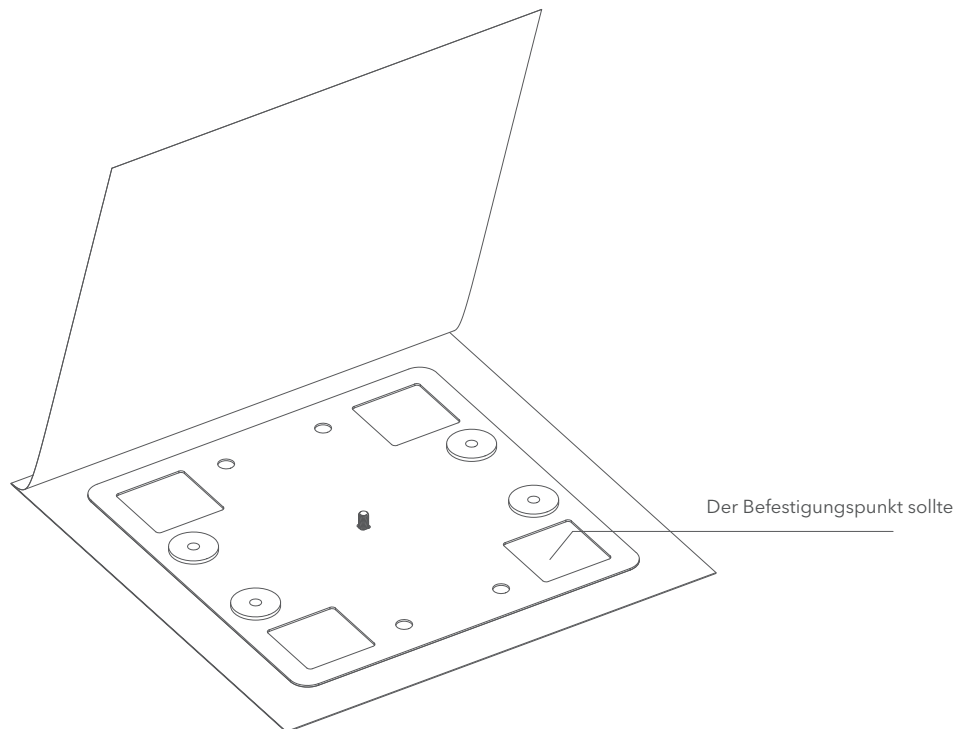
Verschweißen der Membran an den Befestigungspunkten.
